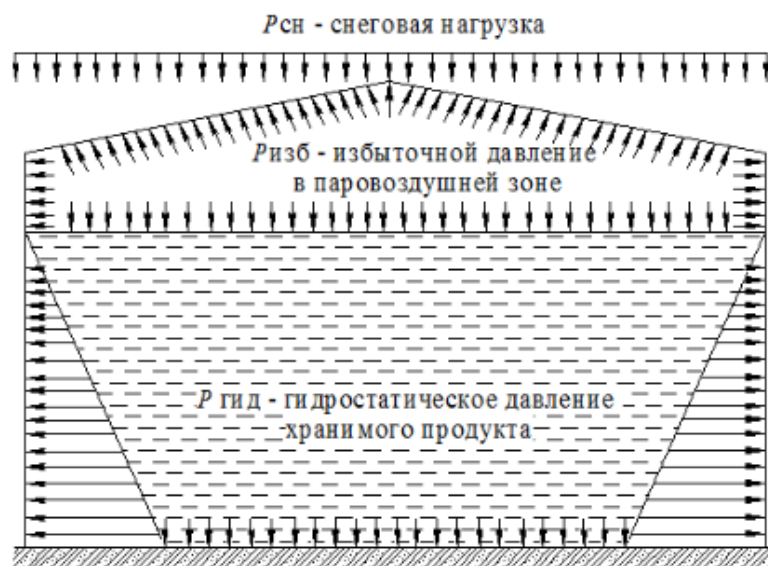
Схема расположения действующих нагрузок на резервуар
